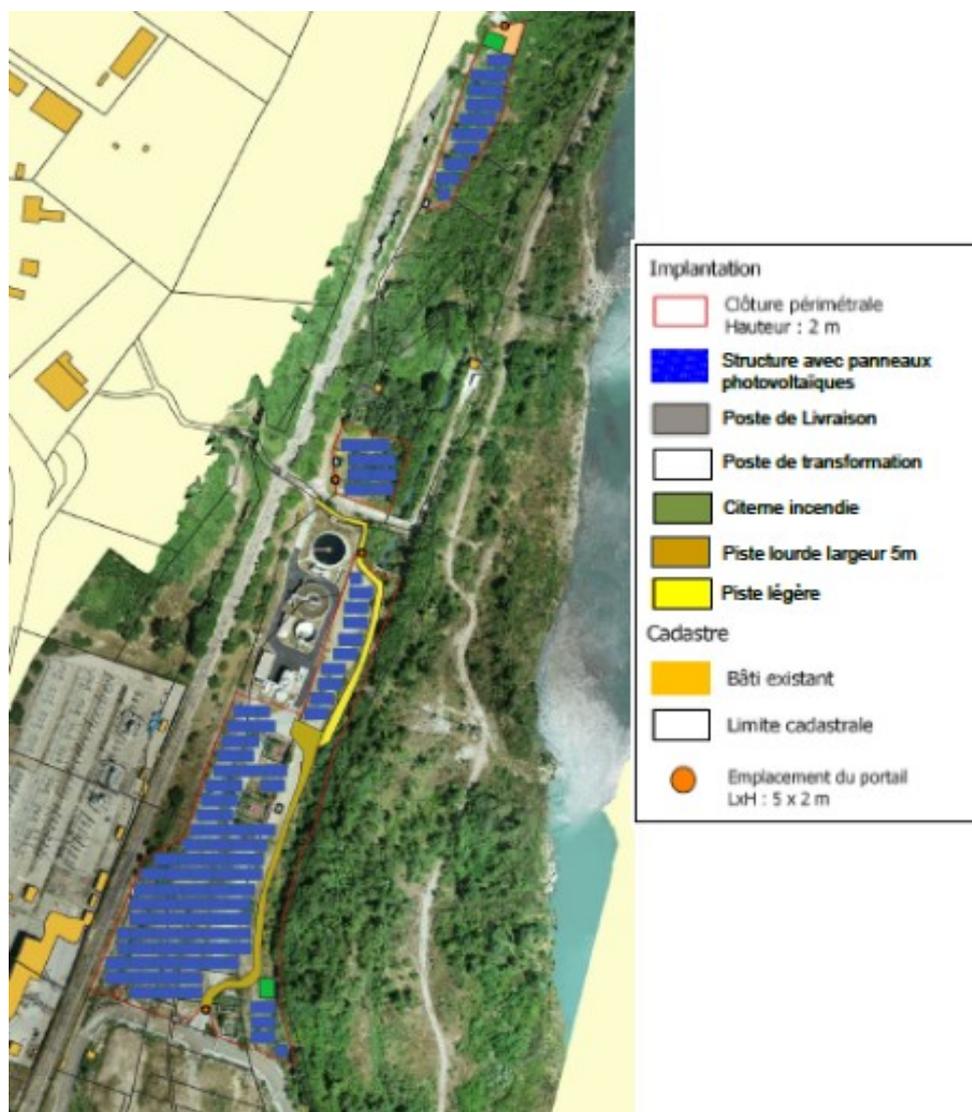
Plan de situation sur orthophoto (source: permis de construire)
